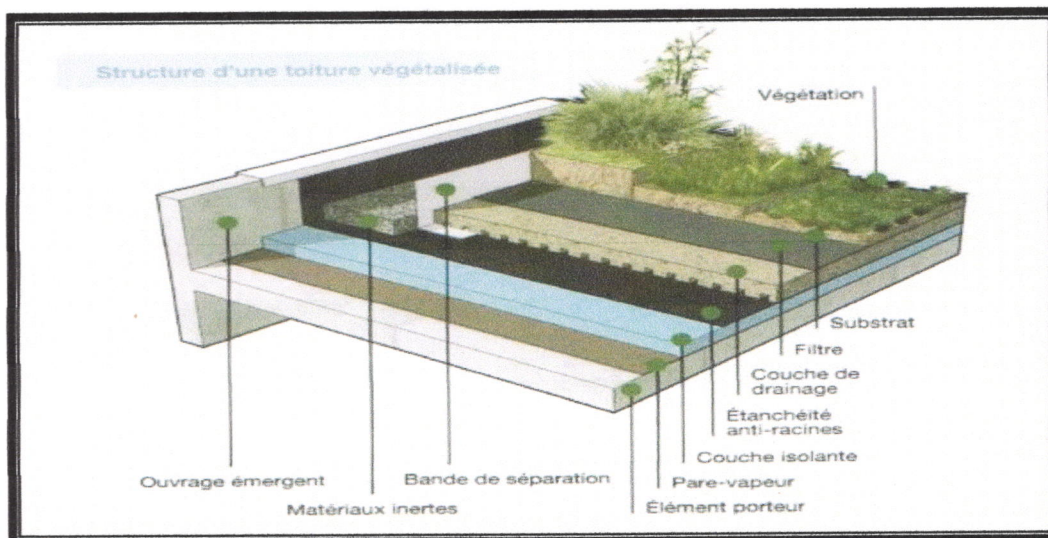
STRUCTURE D'UNE TOITURE VEGETALISME
